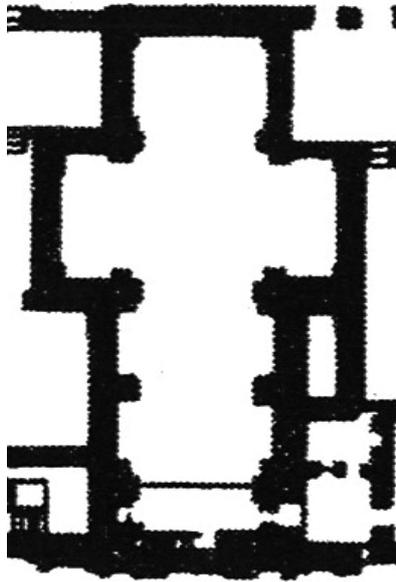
Ehemalige Kirche der Unbeschuhten Karmeliterinnen, Grundriss, 1642, Lwiw.
